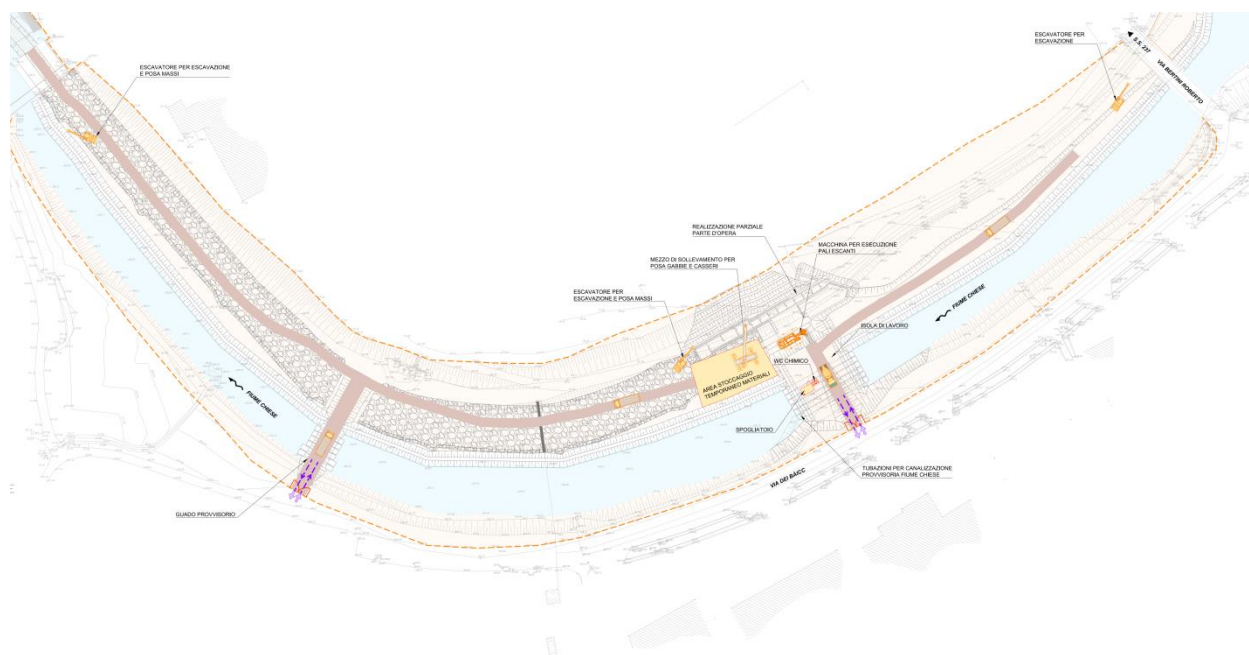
Planimetria indicativa dell'area cantiere operativo zona nuova traversa (in fase esecutiva potranno essere apportati dei cambiamenti)
